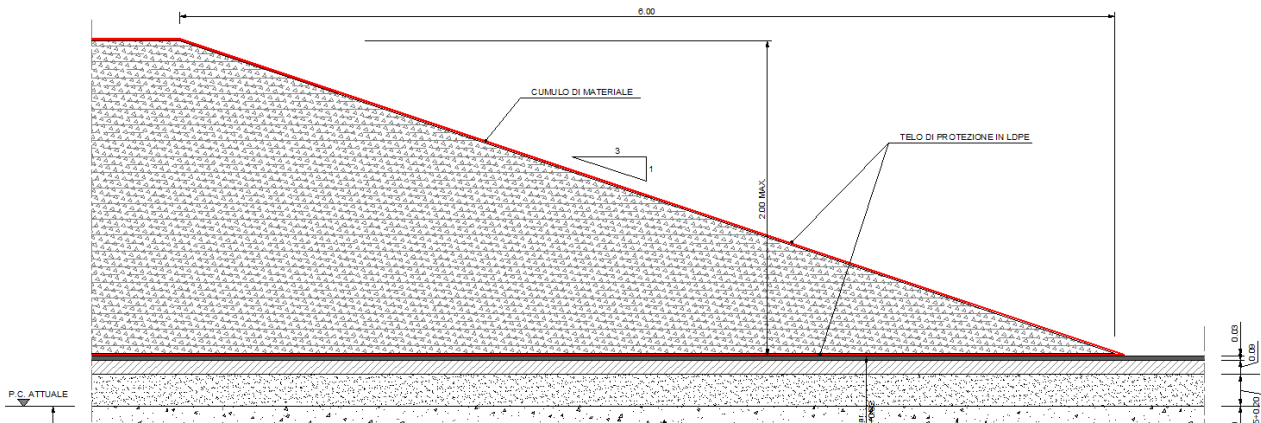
Piazzale di stoccaggio – Sezione tipo cumulo terreni
